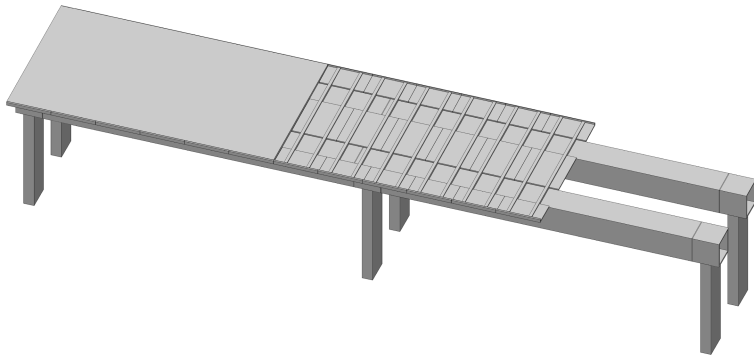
Herstellung eines Bauabschnitts einer mehrfeldrigen Spannbetonbrücke mit dem LT-Brückenbauverfahren (Zeichnung: TU Wien)
